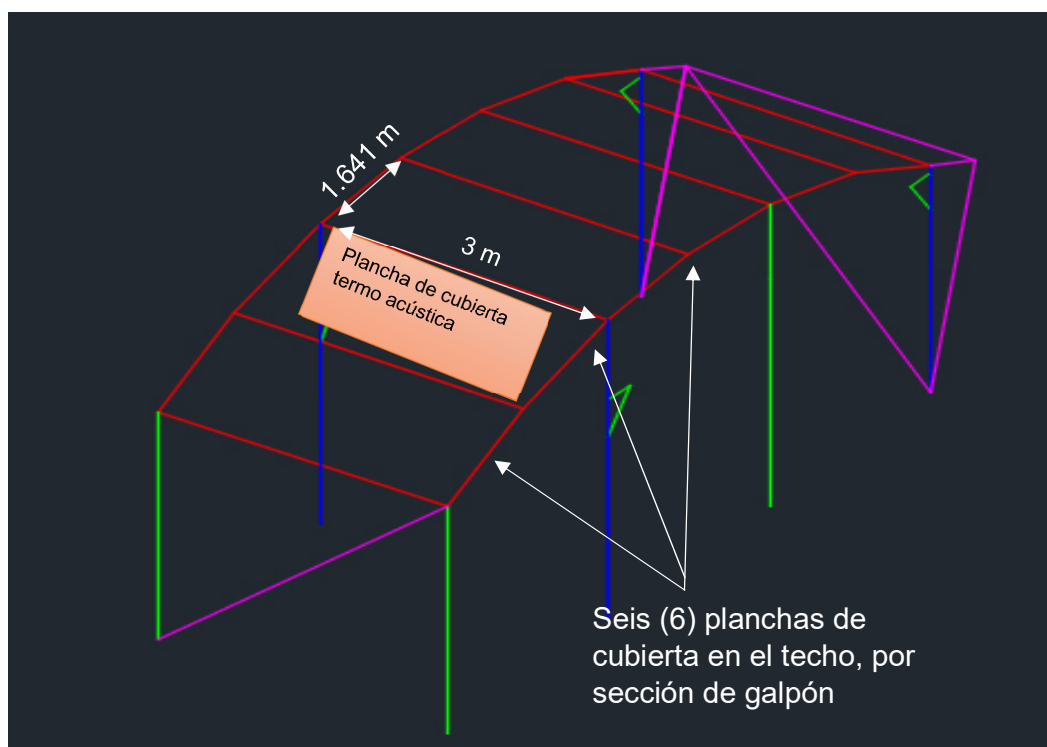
Número de planchas de cubierta termo acústica (Techo) por sección del galpón.
